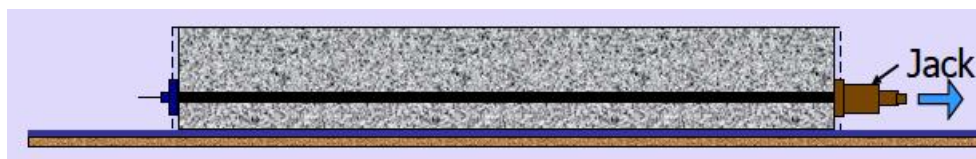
Aplicação do Pré-Esforço (Sengupta & Menon, n.d.).
